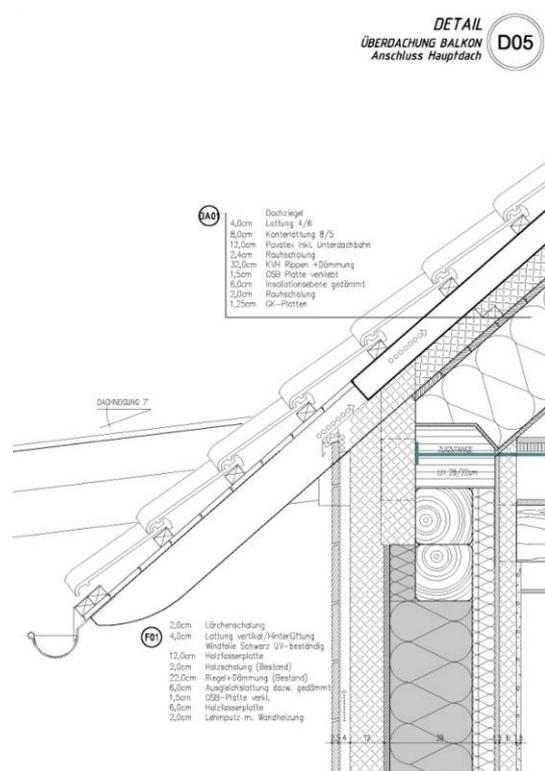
Detail Holzriegelwand mit Anschluss Vordach
